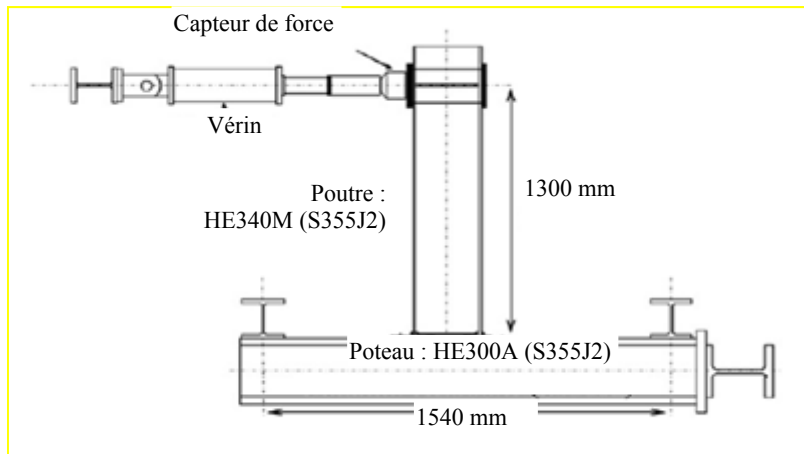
Montage d'essai d'assemblage par platine d'about [Coelho 2006]
